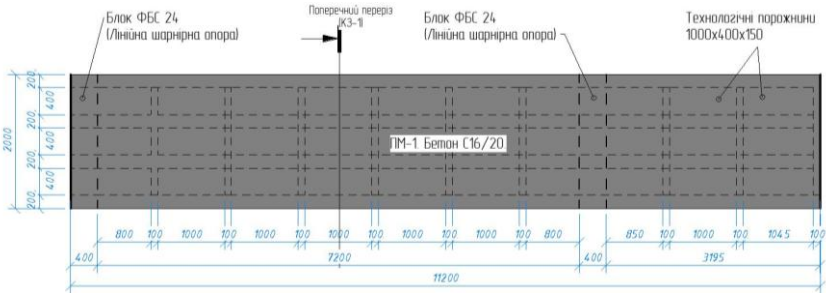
Опалубочний план натурального фрагменту перекриття з порожнистими вкладишами.
